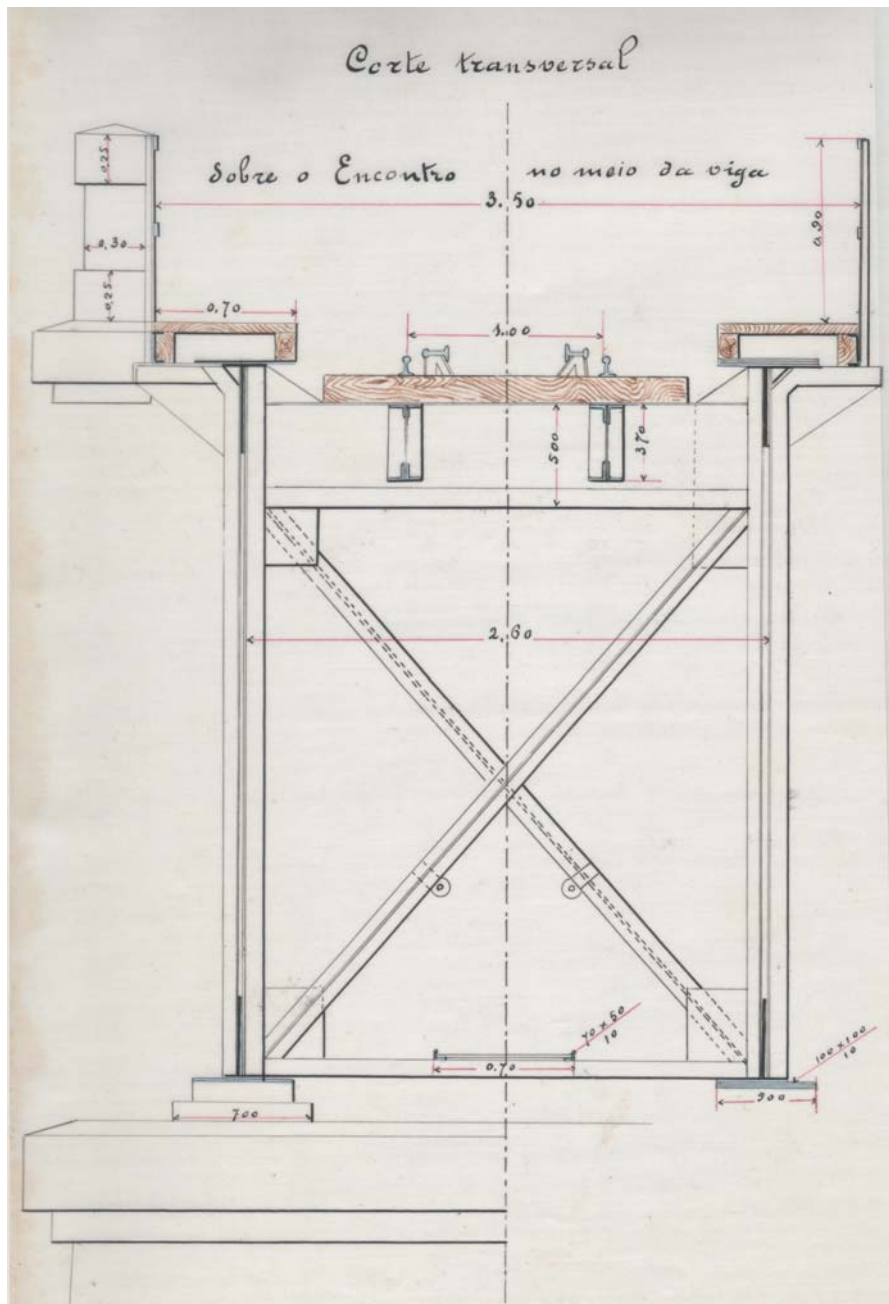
Ponte metálica com 35,0 m de vão – corte transversal (fonte: Arquivo Histórico do Instituto da Mobilidade e dos Transportes Terrestres)
